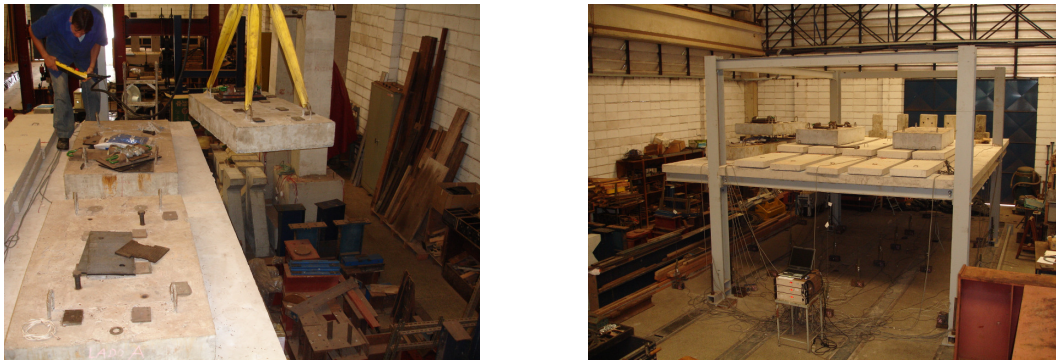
Visão do transporte das placas de concreto e do pavimento tipo carregado.
